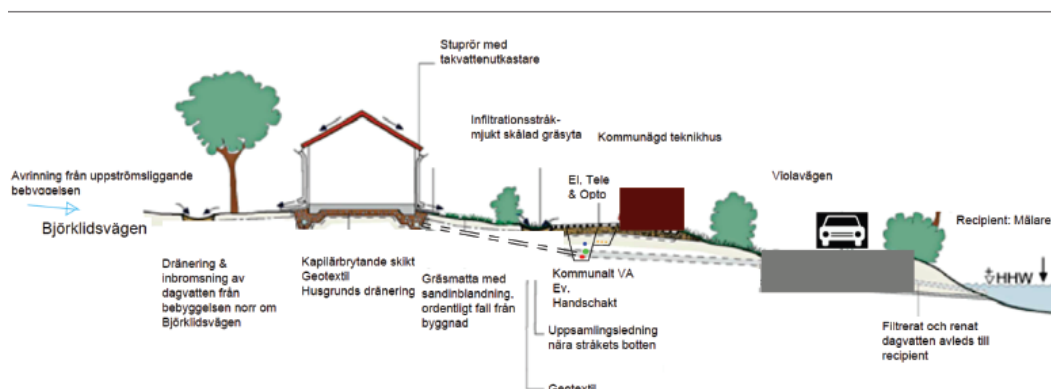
Principsektion för övergripande dagvattenhantering. Källa: Dagvattenutredning, Feron Construction AB
